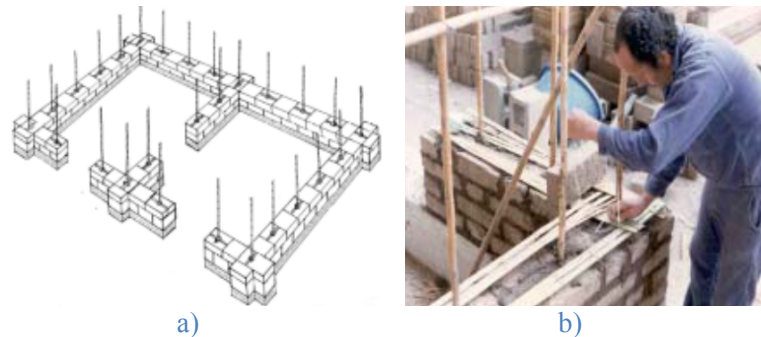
Refuerzo vertical para adobes; a) refuerzo sísmico en esquinas y uniones de muros y b) elementos verticales de refuerzo (Blondet, *et al.*, 2003).
